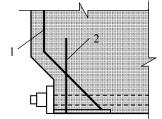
端部凹进处构造配筋 1-折线构造配筋; 2-竖向构造配筋
